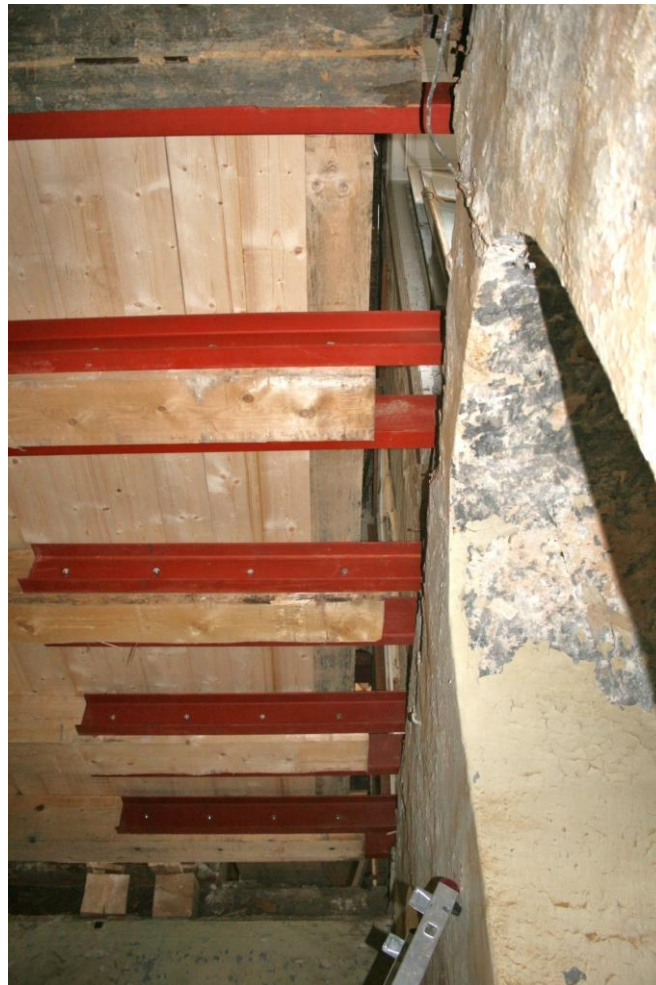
9: Decke (Detail 2): Metallkonstruktionen halten die Deckenbalken, Sicherungsmaßnahme von 2015, um die neuen Holzbauteile vom mit Hausschwamm befallenen Mauerwerk zu entkoppeln
